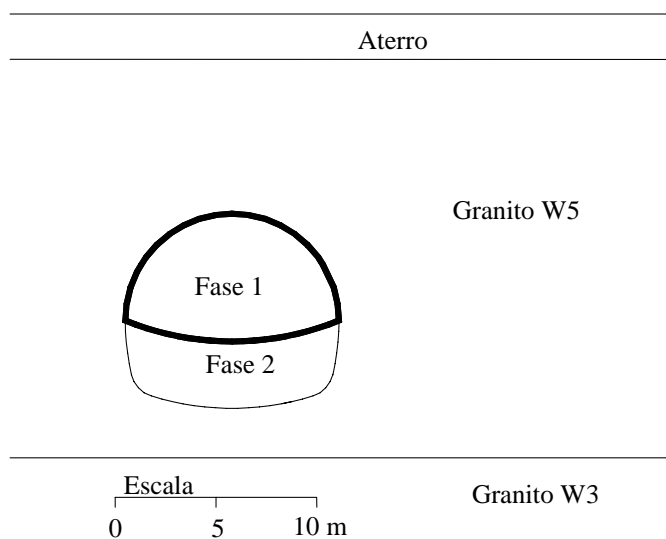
Secção transversal do túnel e perfil geotécnico da secção analisada
